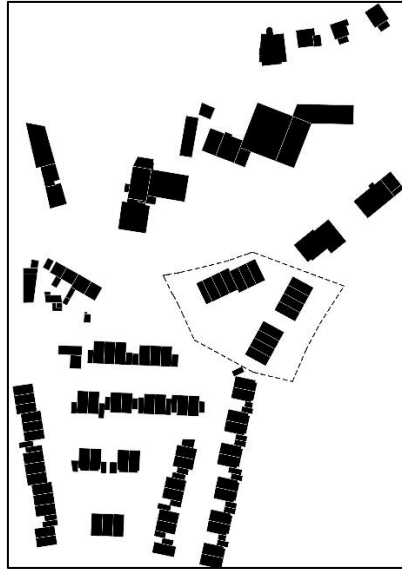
Schwarzplan mit Markierung des Plangebietes (schwarz-gestrichelte Linie)
